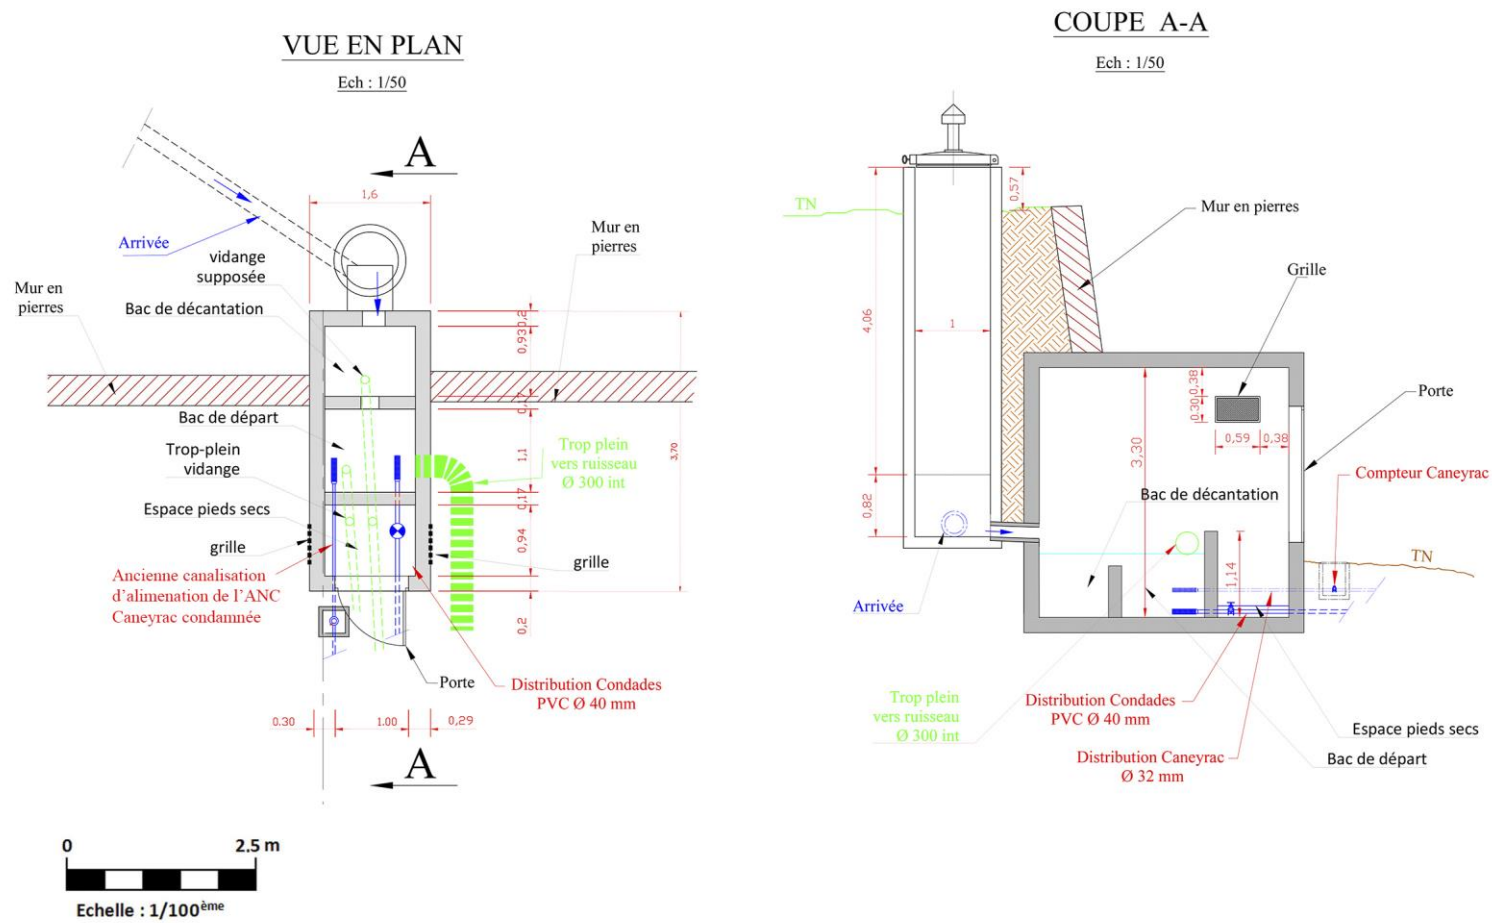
Plan du captage et de l'ouvrage de collecte des eaux
